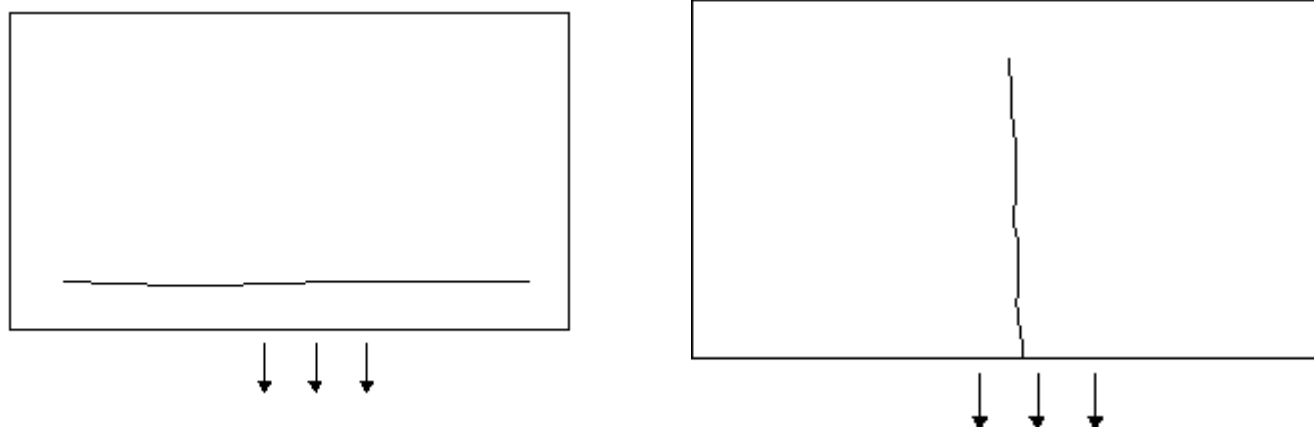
Fisuras en tabiques divisorios por cedimiento de losa
